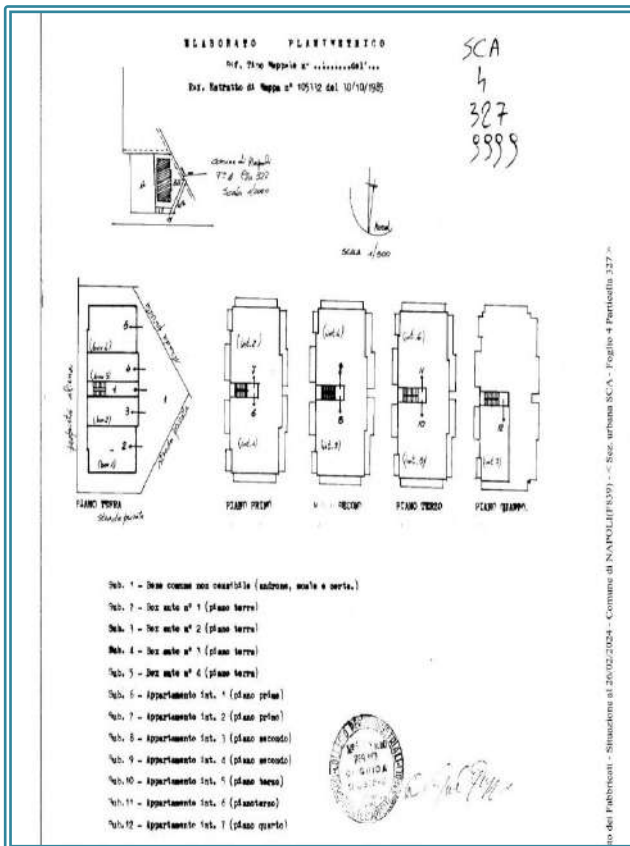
Elaborato planimetrico (TUTTI I LOTTI)
